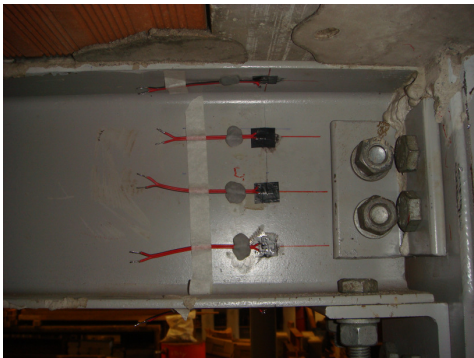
Vista da instrumentação das vigas e armaduras
